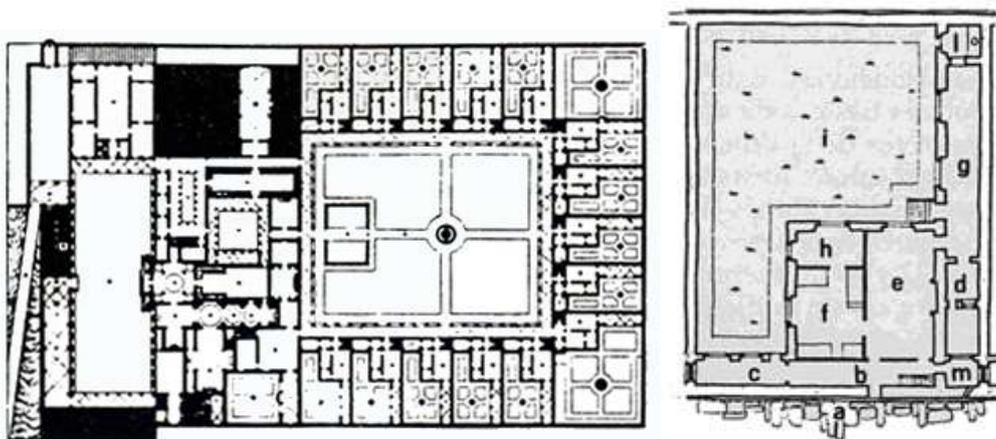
Planta da *Certosa* de Ema e pormenor de uma planta da cela dos monges (SHERWOOD, 1983).
